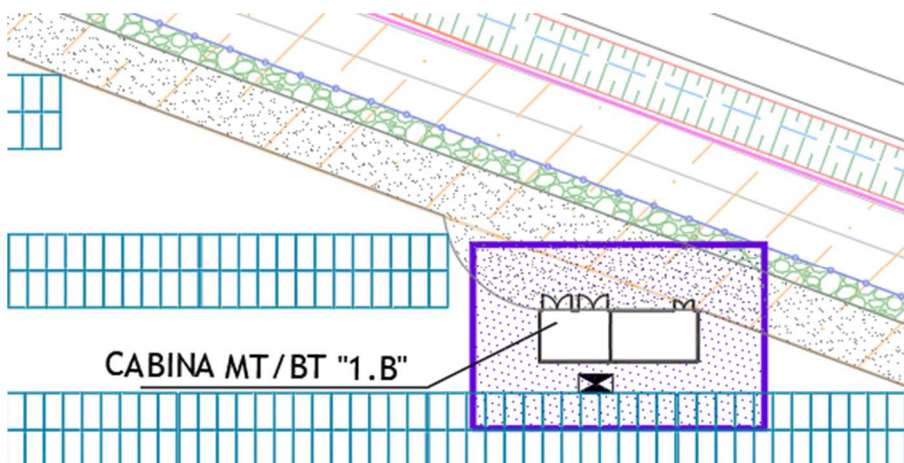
Individuazione fasce di rispetto Cabina MT/BT 1.B
